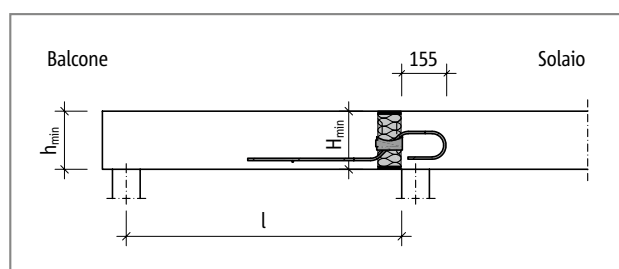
Schöck Isokorb® T tipo QL-V1 - QL-V3: schema statico
